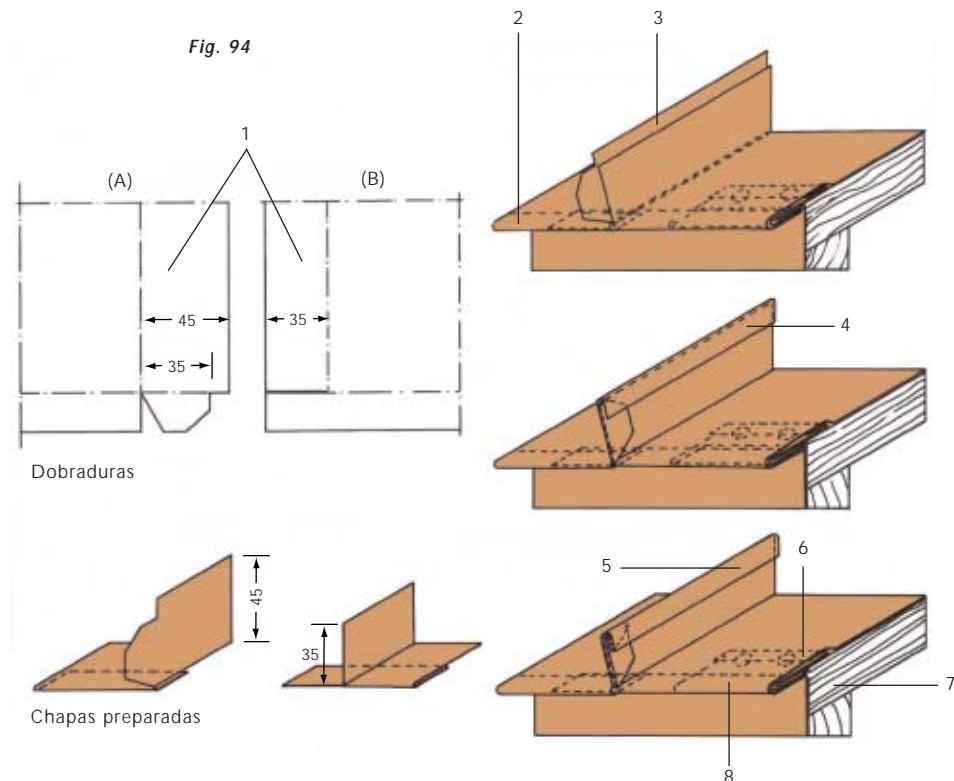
Preparo das chapas e execução da junta elevada encaixada com o pé da vertente.
